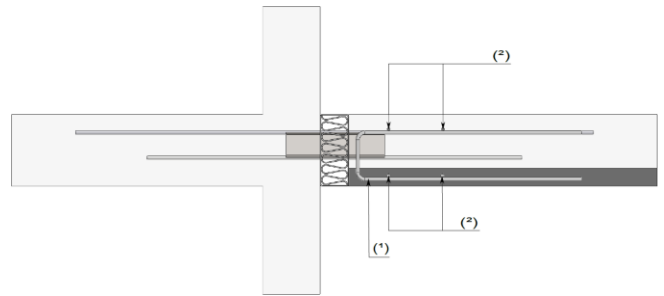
Chainage en rive de plancher – liaison dalle à prédalle – balcon – disposition 2
